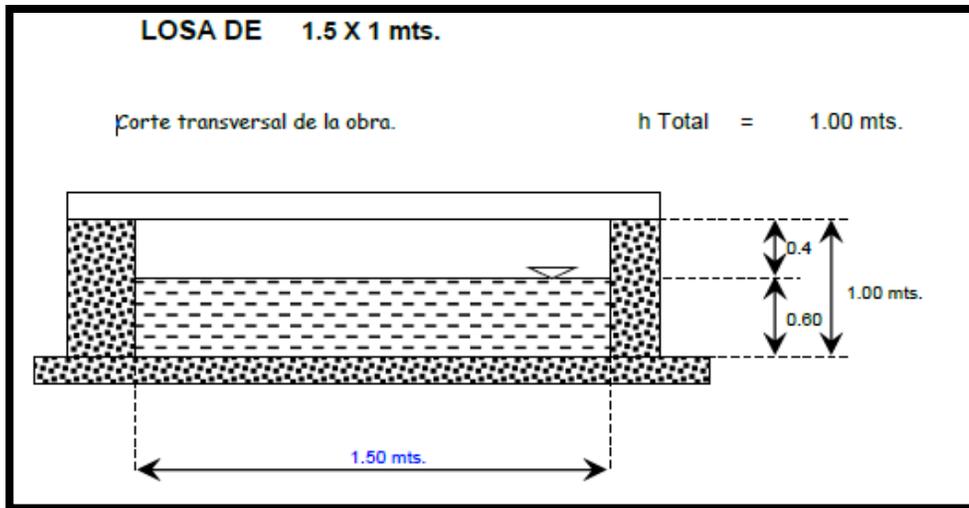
Alcantarillas de loza de 1.5 x 1 m.
